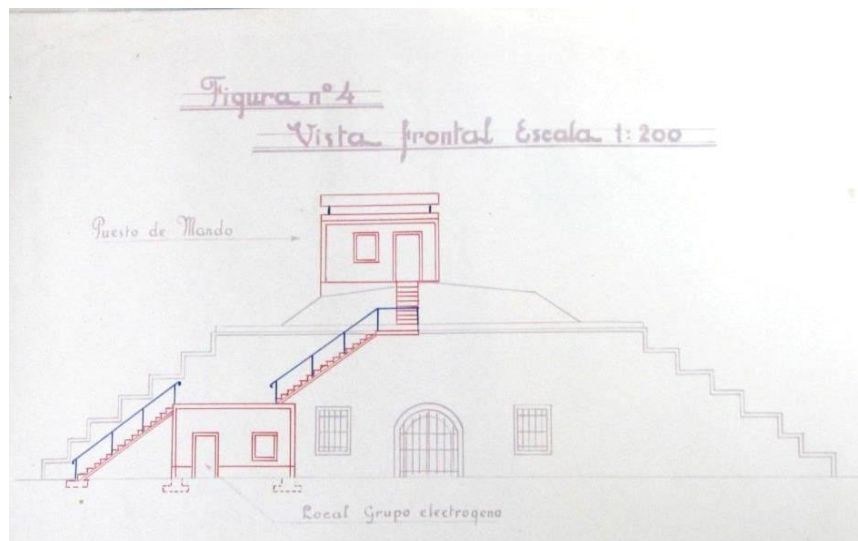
Alzados anteproyecto Torre. Planos cedidos por el Archivo Militar.
